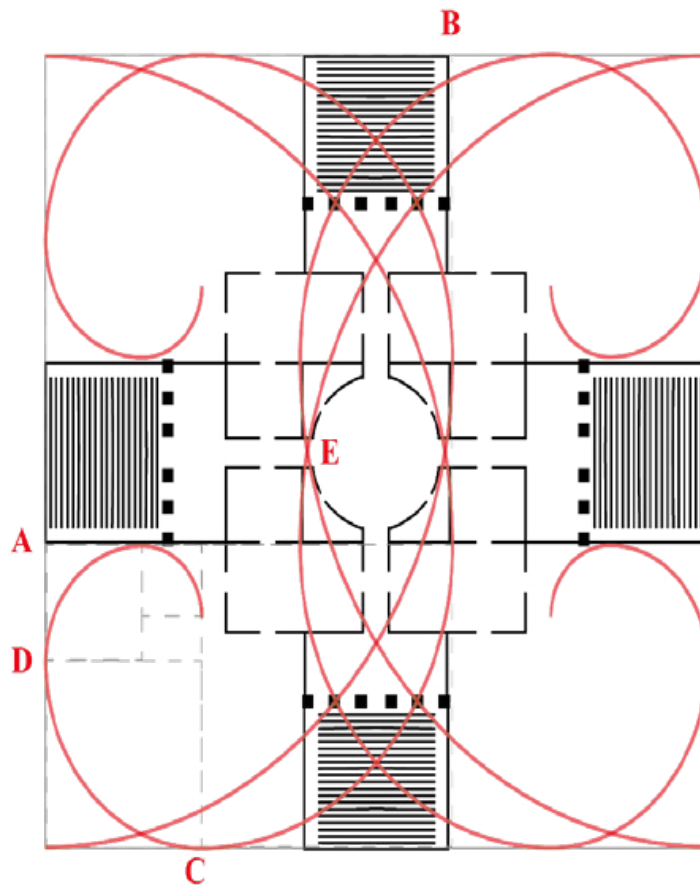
Proporção áurea aplicada sobre a planta baixa da Villa Capra. Fonte: elaborada pelos autores, 2019.
